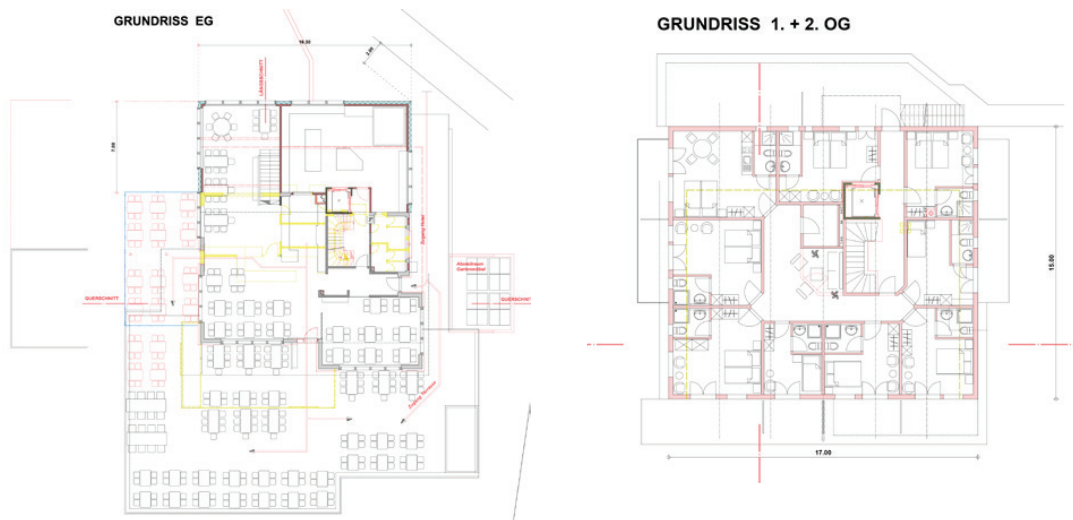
Grundrisse der geplanten Nutzungen und im Erdgeschoss und im 1. und 2. Obergeschoss des Berggasthauses Höchst (Quelle: Gottfried Schmid, Mai & August 2025)
